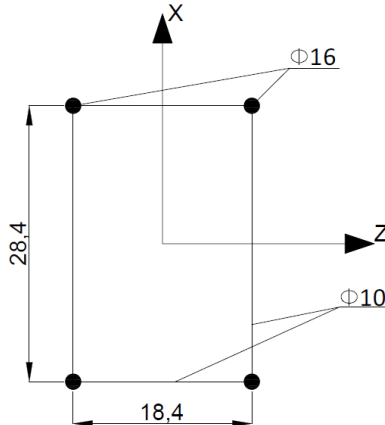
Seccion transversal de la columna (dimensiones relevadas)
